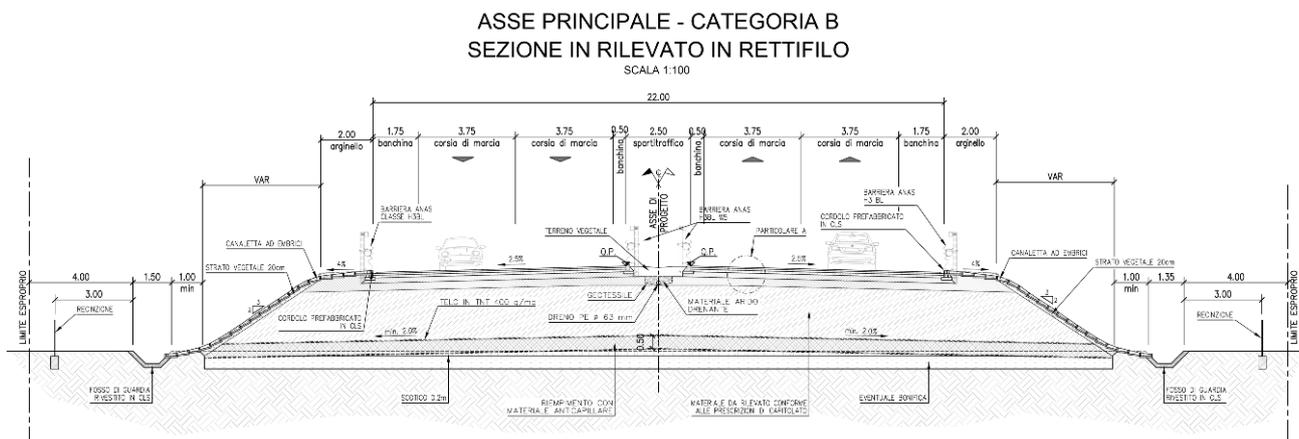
Sezione tipo in rilevato dell'asse principale
